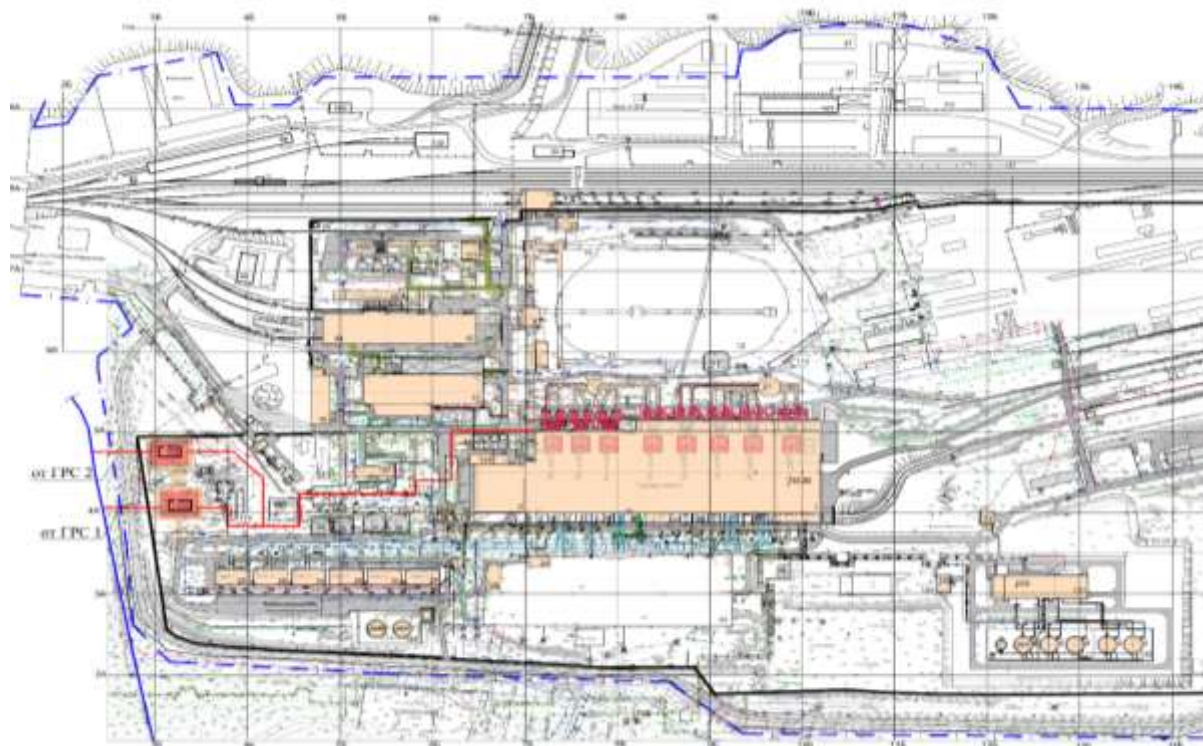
Вариант 1.* Схема генерального плана ТЭЦ-2
